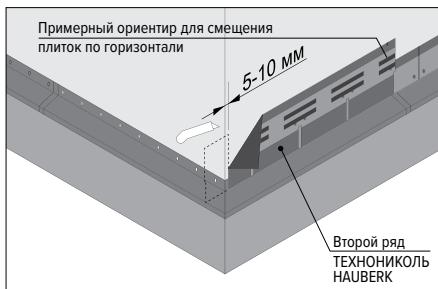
Монтаж первого и последующих рядов фасадной плитки
